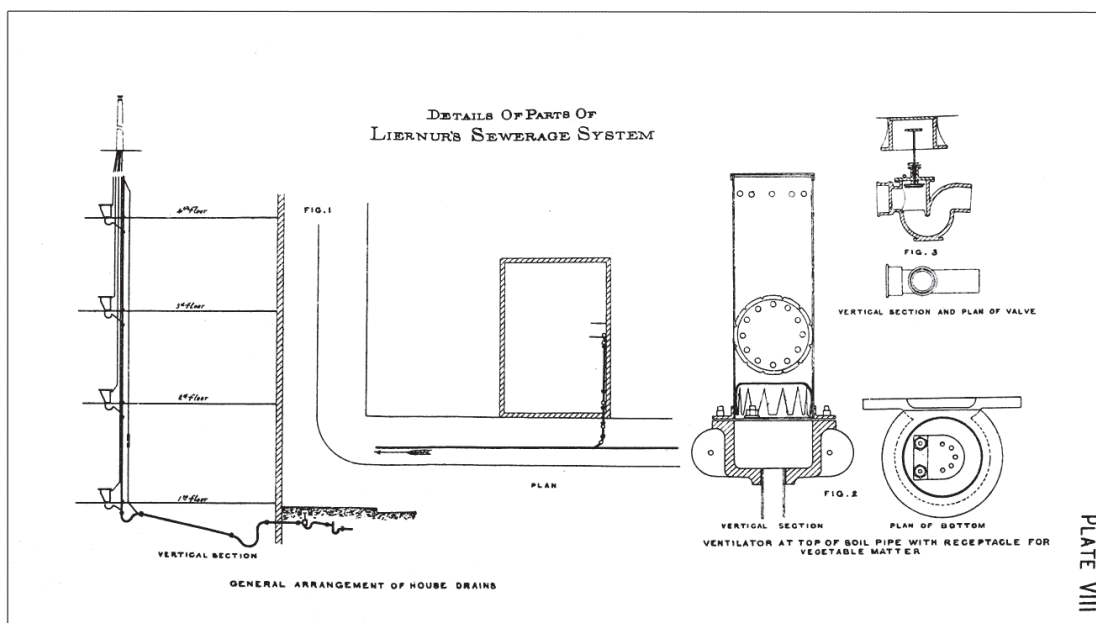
Detalhes de partes do sistema Liernur: seção vertical de uma edificação, apresentando as tubulações e conexões; planta da saída da tubulação da edificação para a rua; seções do ventilador no topo da tubulação do solo. Fonte: GRAY, 1884.
